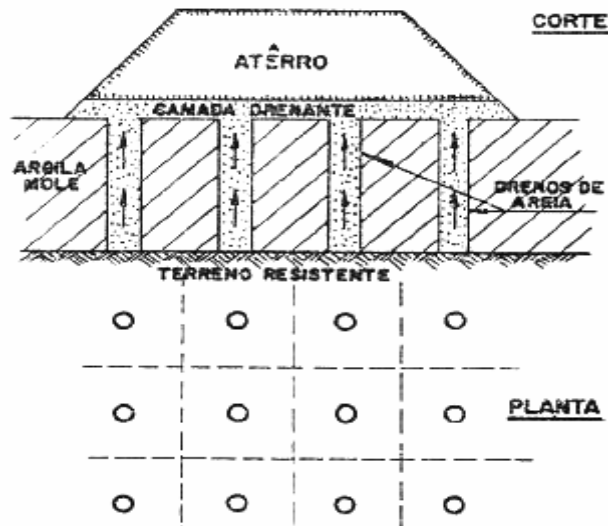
Consolidação da fundação argilosa de aterro por meio de drenos verticais.
